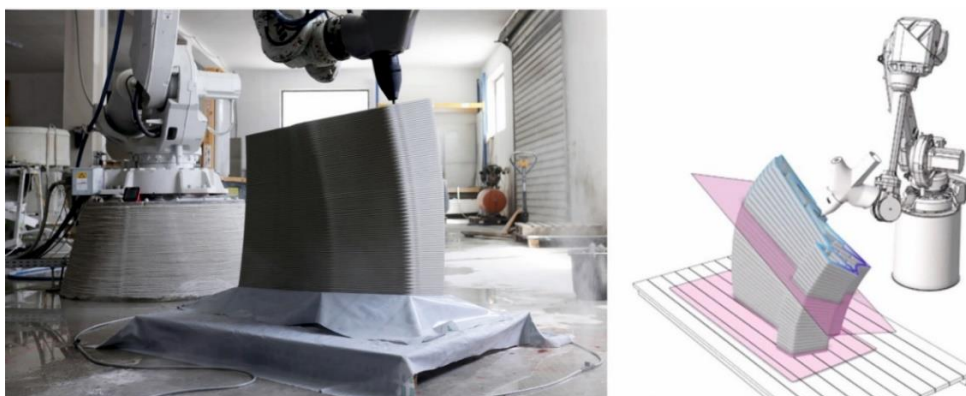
3d печать строительных блоков моста Striatum Bridge
